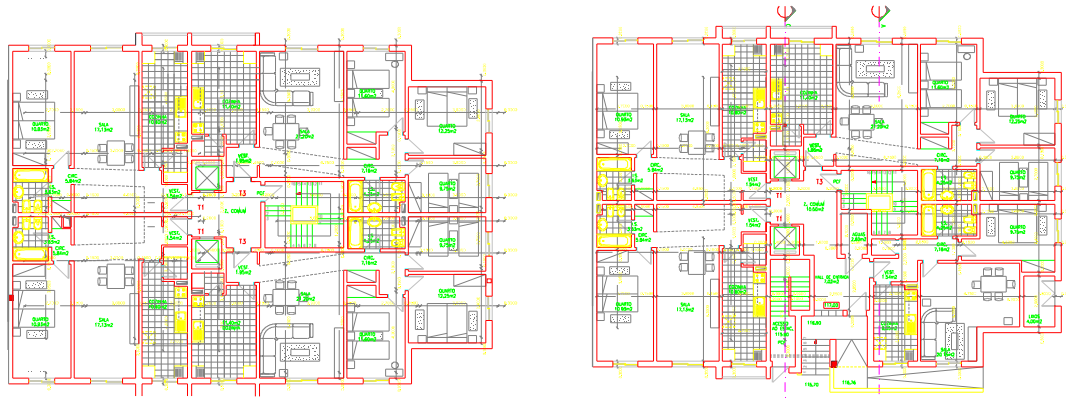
Planta do piso 1,2,3 e 4 de habitação e planta do piso 0.
